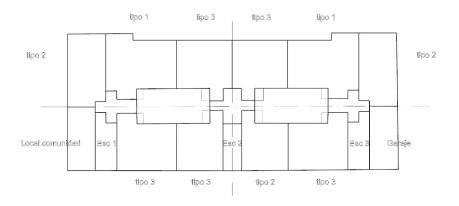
Tipos de viviendas en la planta baja. 2014. Medición actual. Propia.
